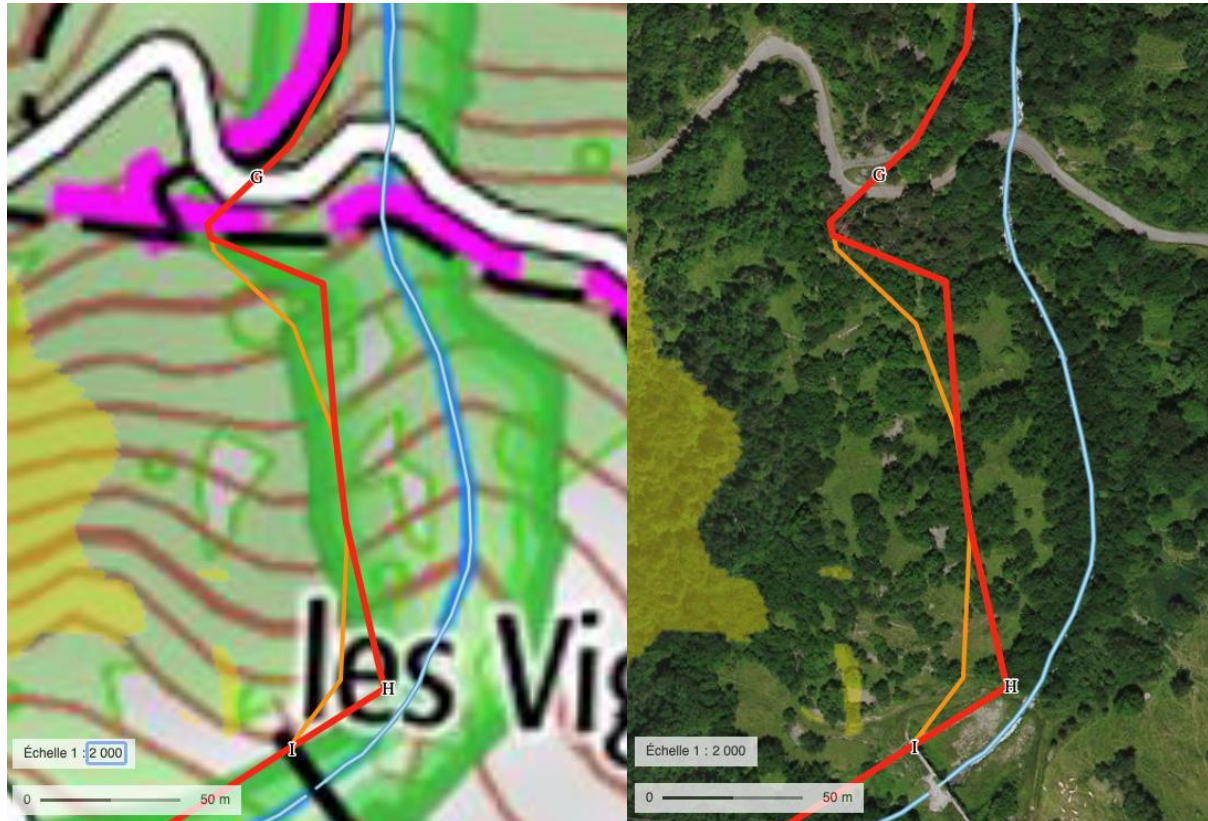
Tracé de la conduite entre le point G et le point I et variante (source : géoportail.gouv.fr).
